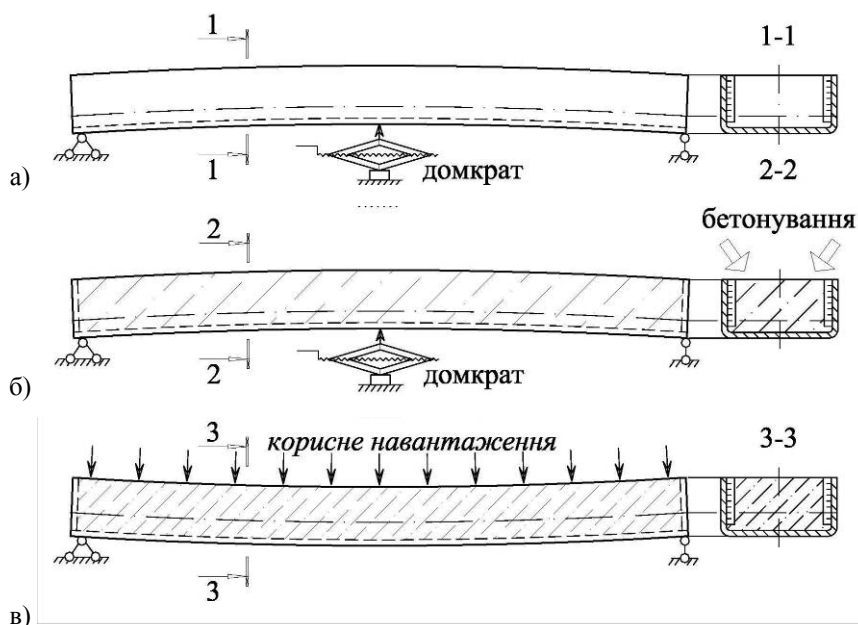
Схеми створення попередньо напруженого сталобетонного прогону: а) сталевий елемент; б) перетворення сталевих елементів у сталобетонні; в) сталобетонний елемент
